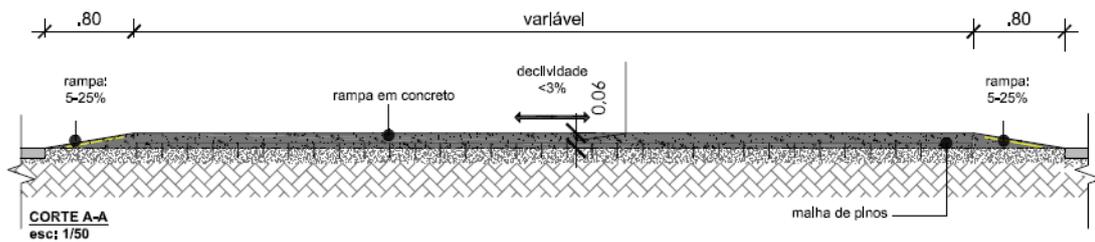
Detalhe construtivo em corte longitudinal da faixa elevada
